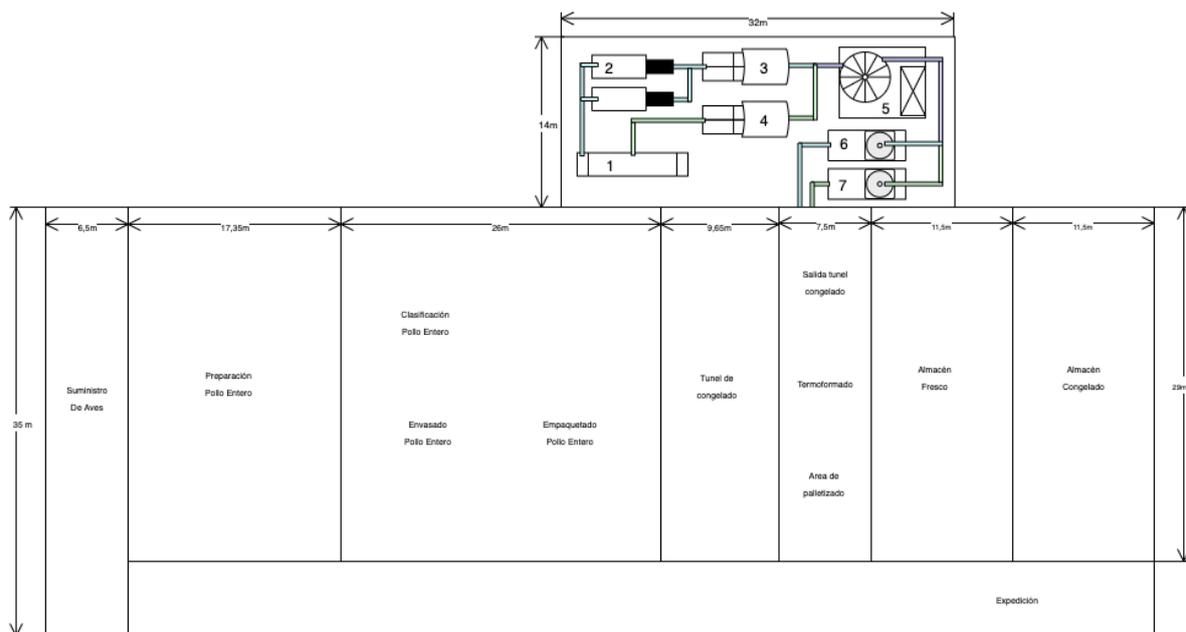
Lay-out* propuesto para la planta de Que Rico.
